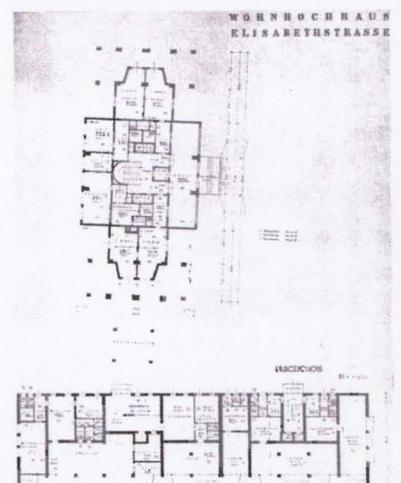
Grundriss Elisabethhochhaus und Zubau mit Geschäften und Wohnungen
